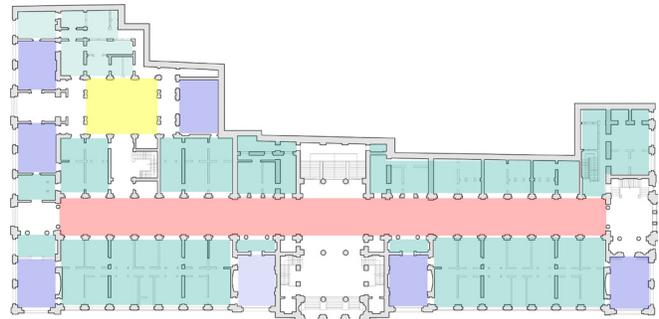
Elementos Palacio de Tribunales en planta nivel 1.
